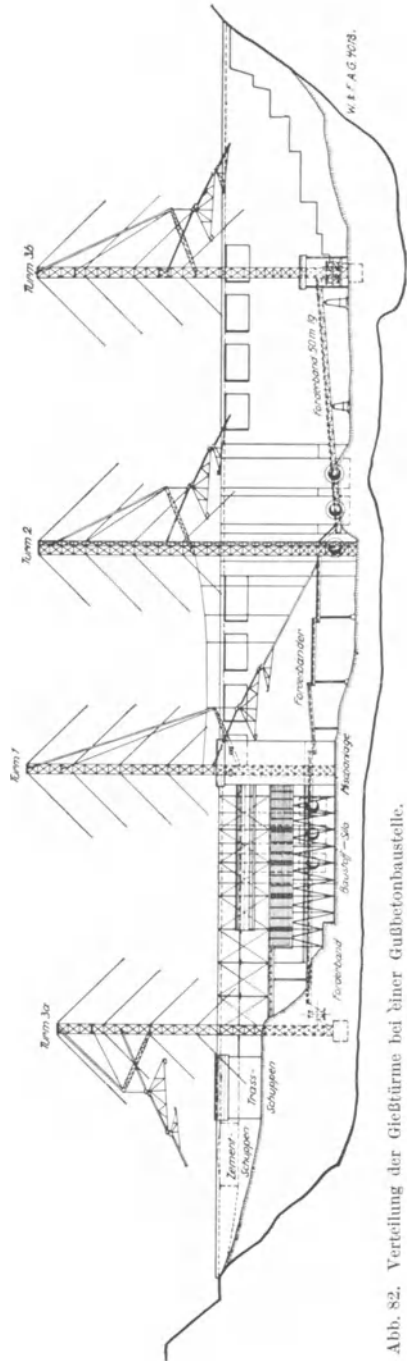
Verteilung der Gießtürme bei einer Gußbetonbaustelle.
